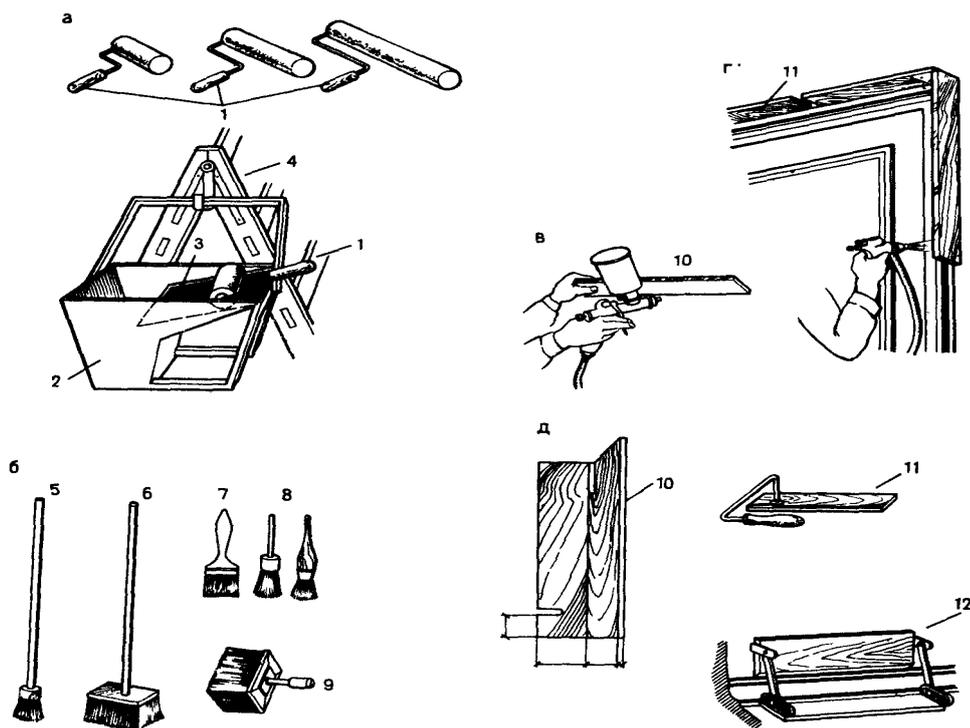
Инструмент и приспособления для окрашивания поверхностей вручную
